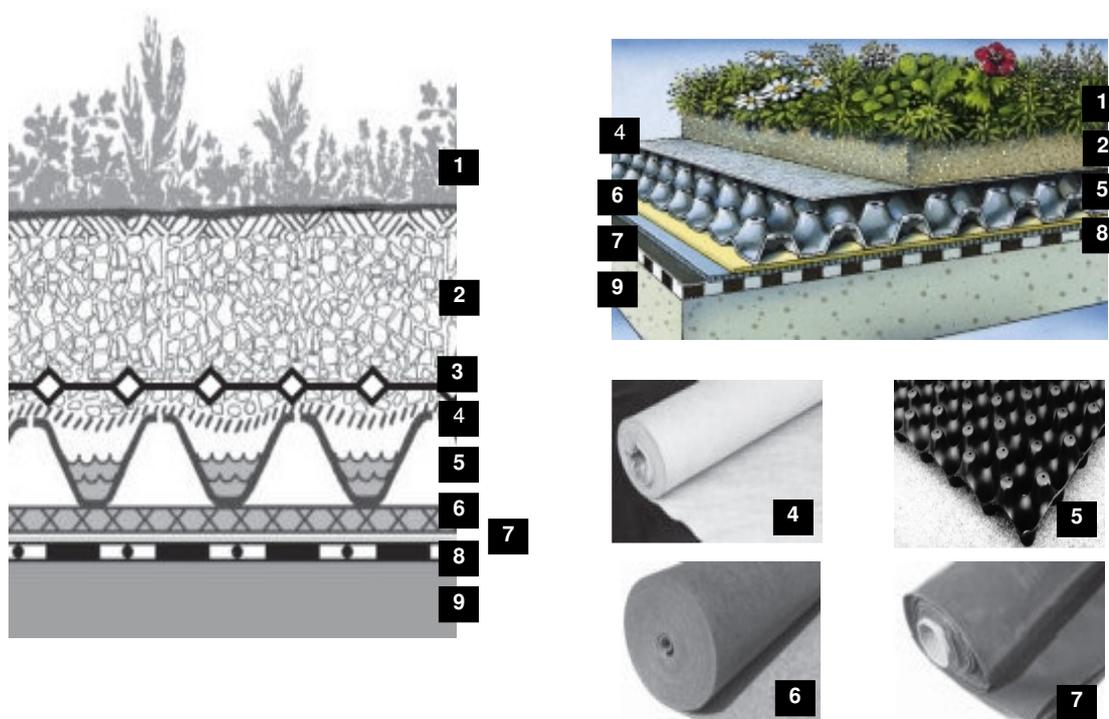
Sistema “Sedum Carpet” com Floradrain FD 25®. Exemplo de sistema patenteado de cobertura verde do tipo extensivo para coberturas planas com vegetação do tipo sedum. 1. Vegetação; 2. Substrato; 3. Fallnet-SK; 4. Manta de Flitrage SF; 5. Elemento de drenagem Floradrain FD 25; 6. Manta de proteção e retenção de água SSM 45; 7. Barreira contra raízes WSF 40; 8. Camada de impermeabilização da cobertura; 9. Laje. Fonte: ZINCO, s/d.
